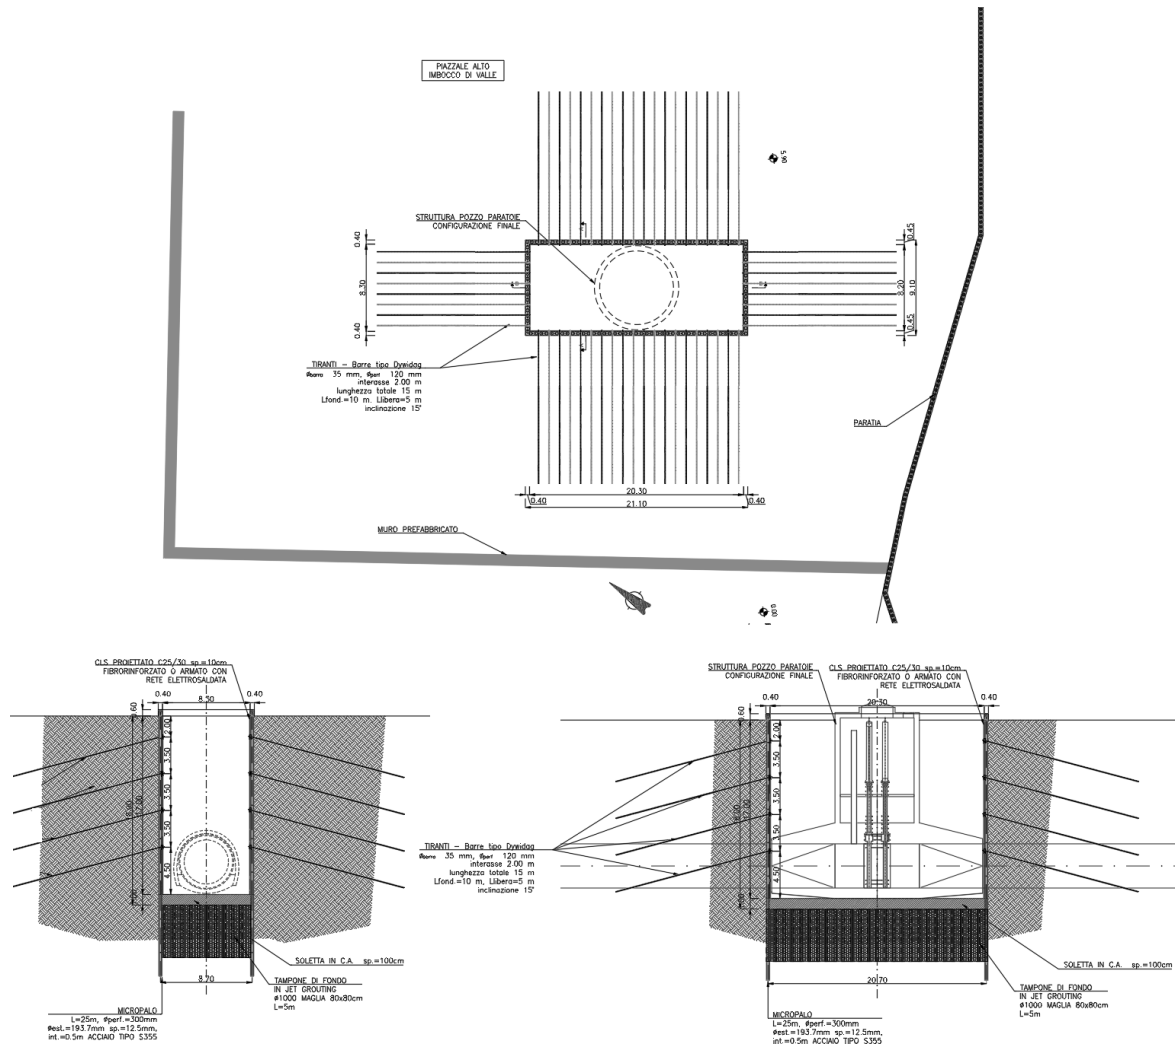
Pozzo Paratoie: planimetria e sezioni
